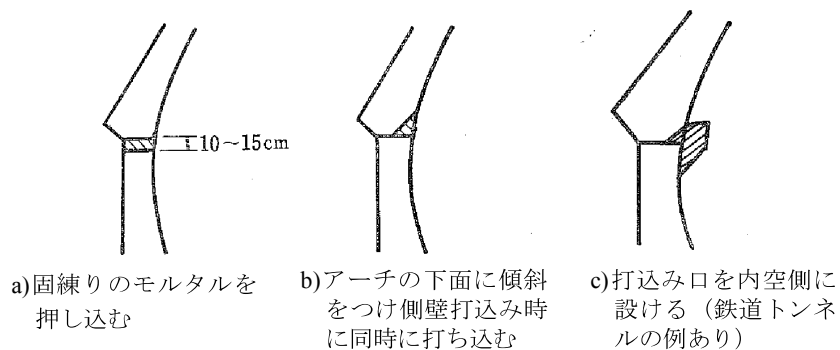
アーチと側壁のせめ部の施工⁷⁾を加筆修正
